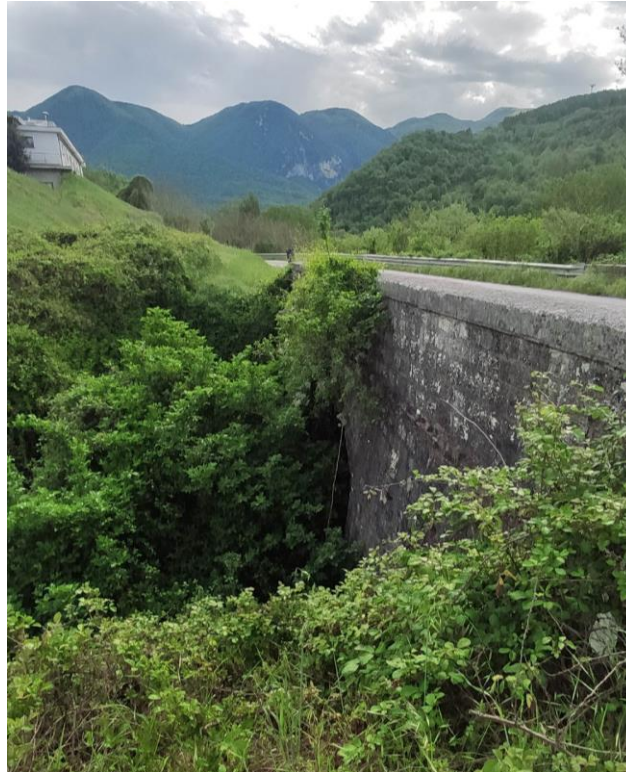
S9 – Vista sottopasso idraulico Prospetto nord
